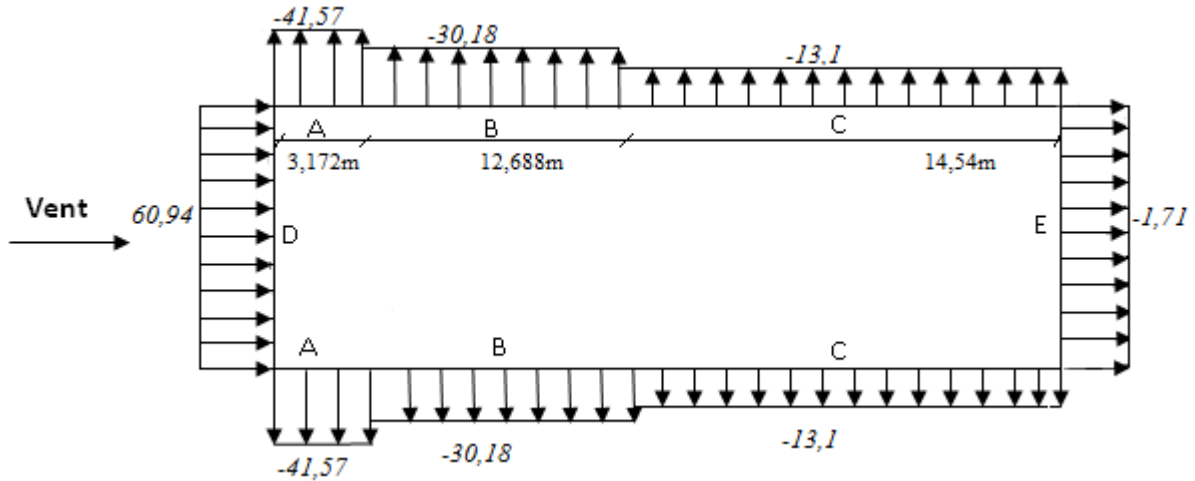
Pression statique du vent q_j sur les parois verticale (vent sur pignons 1 ; 2)
